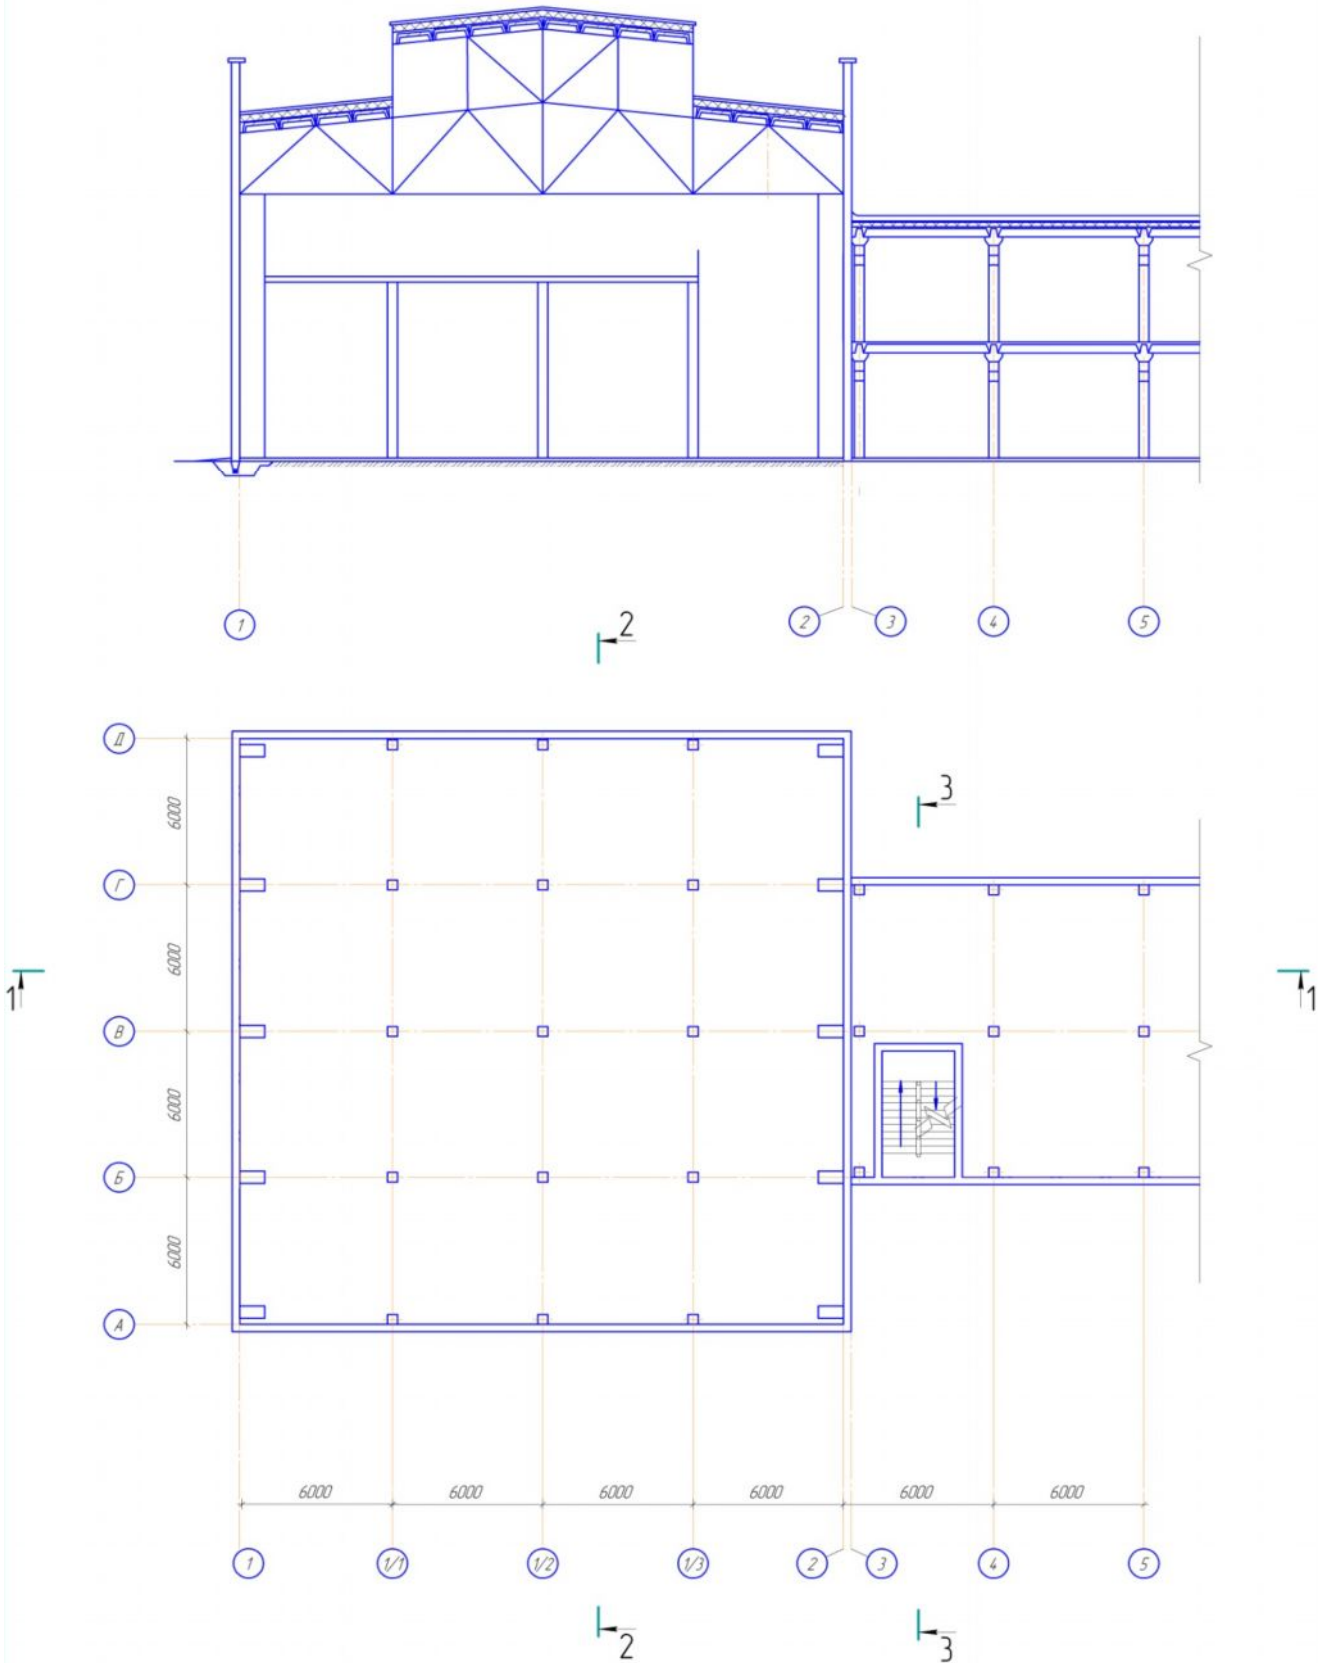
Схема плану та розрізу промислової будівлі до завдання контрольної роботи
